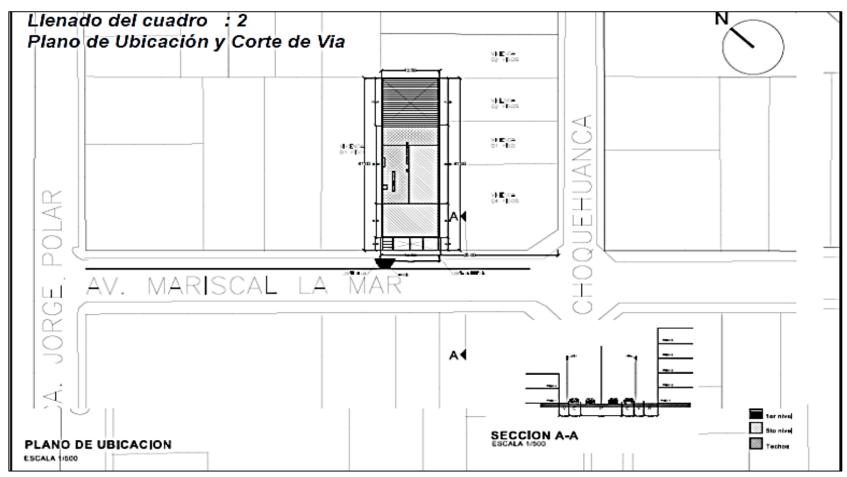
Plano de localización y corte de una vía. Fuente: Autoría propia.
